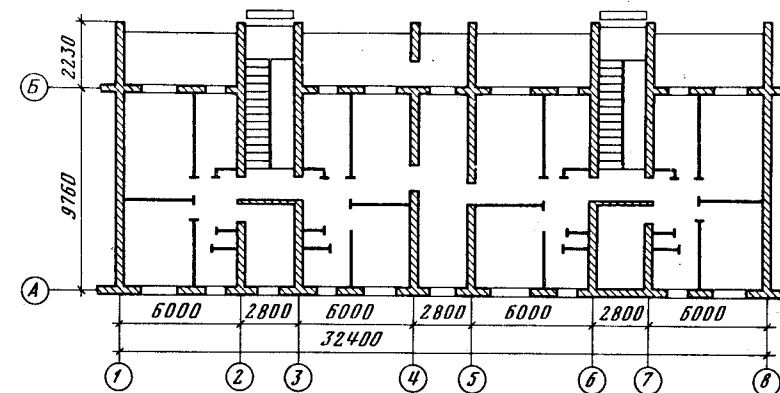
План этажа двухэтажного кирпичного жилого дома
